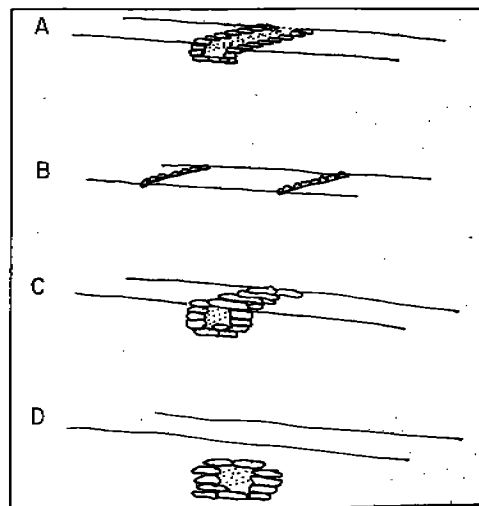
Diversos sistemas de drenaje del camino incaico: A) canal abierto revestido de piedras; B) drenajes de piedras sobreelevadas; C) canal cubierto a nivel del camino; D) canal cubierto bajo el nivel del camino.
